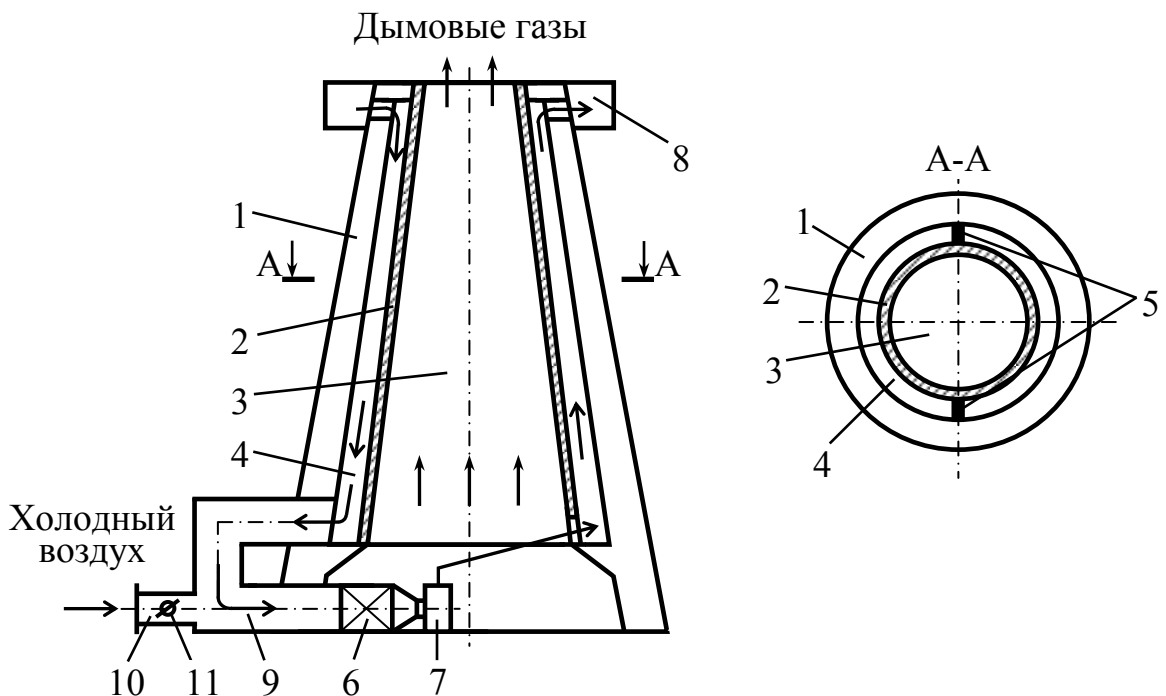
Дымовая труба с воздушным каналом, в которой осуществляется рециркуляция подогретого в калорифере воздуха: 1 – железобетонный ствол; 2 – футеровка; 3 – газоотводящий канал; 4 – воздушный канал; 5 – вертикальные перегородки; 6 – калорифер; 7 – вентилятор; 8 – кольцевой короб; 9 – короб подвода воздуха к калориферу; 10 – патрубок; 11 – регулирующий орган
